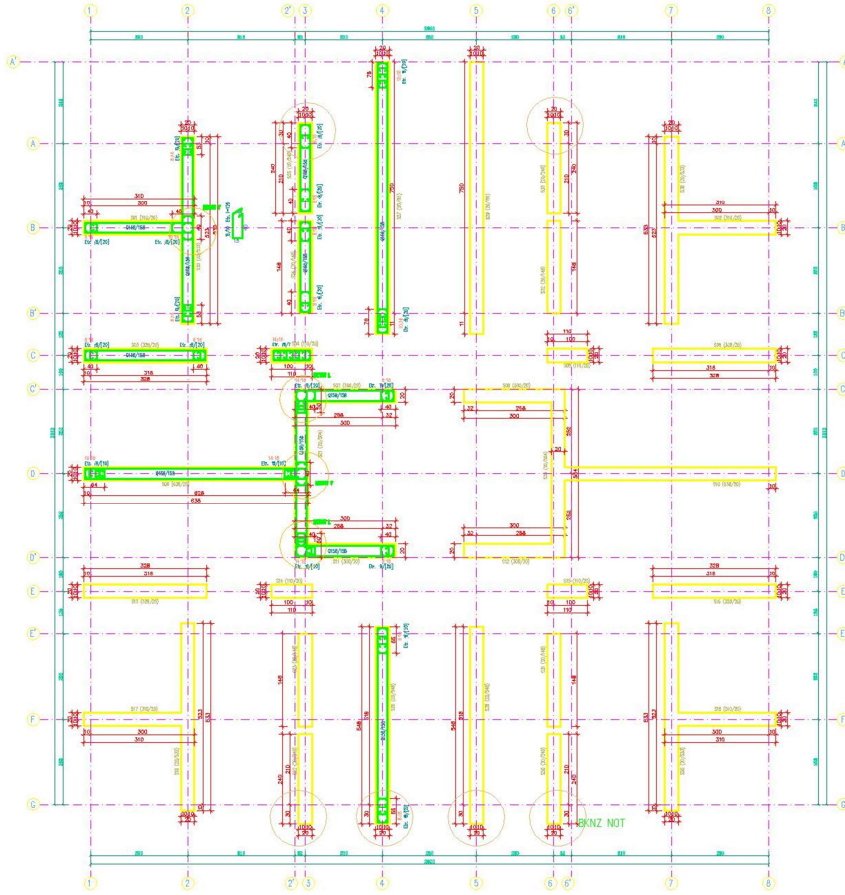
0 m- 5,82 m kotları arası kolon aplikasyon planı
